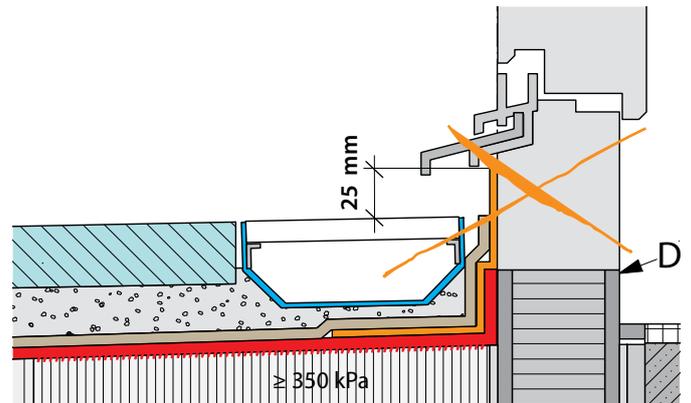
Hauteur minimale de l'étanchéité avec des cadres de fenêtres en matériaux putrescibles
